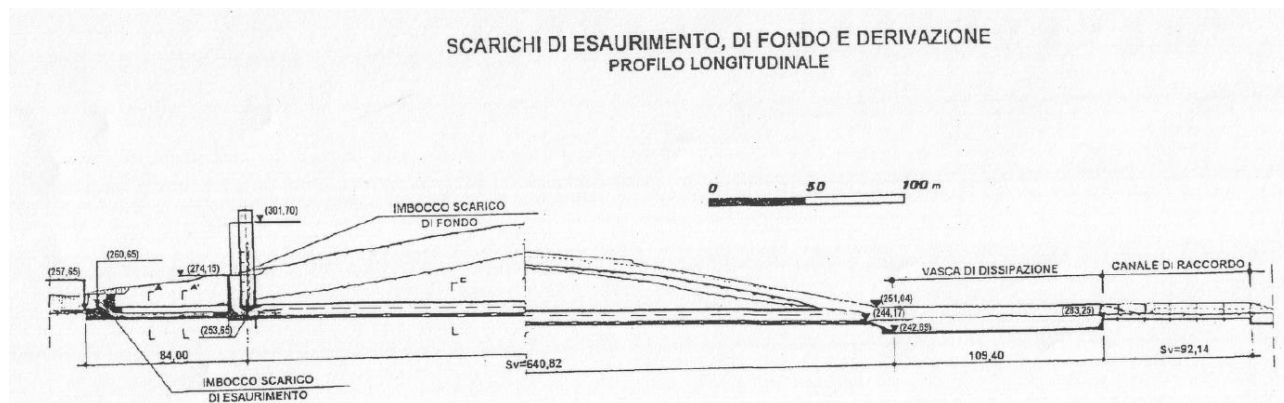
scarichi di esaurimento, di fondo e derivazione – profilo longitudinale
